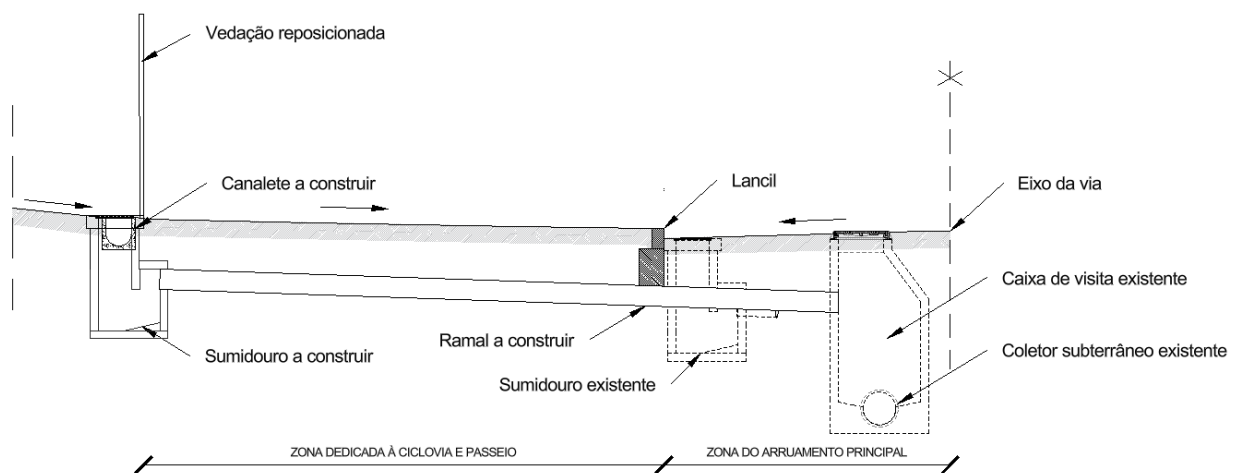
Perfil transversal tipo da rede de drenagem pluvial a construir com descarga na rede existente.
